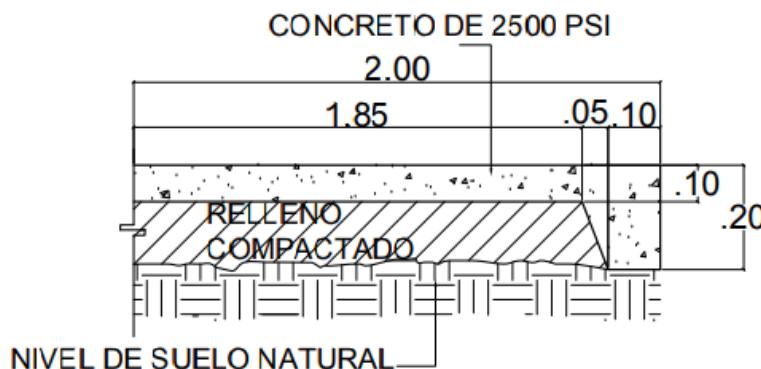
Detalle de acera. Fuente: Plano de anteproyecto
